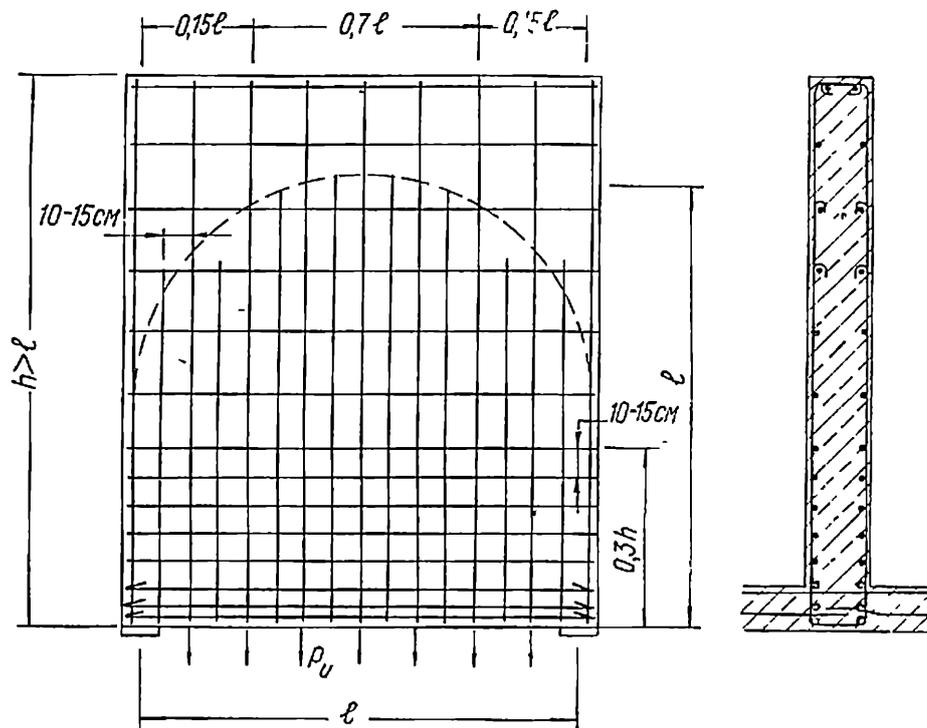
12а. Армирование балок-стенок с подвесной нагрузкой
